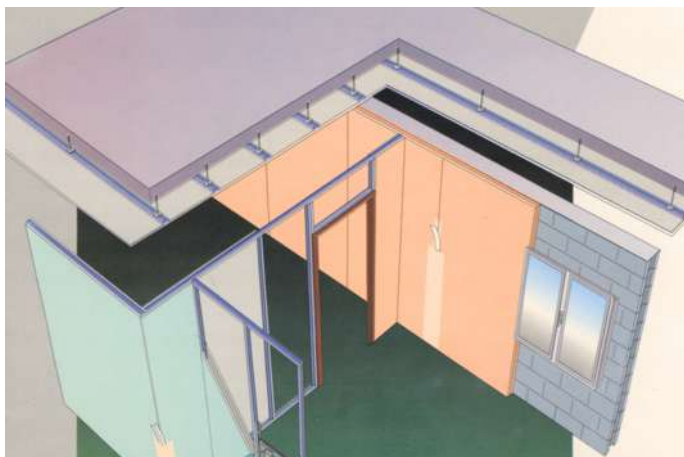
Sistema de vedação interno em gesso acartonado (*dry-wall*) para paredes internas de áreas secas e molhadas e também para forros.
